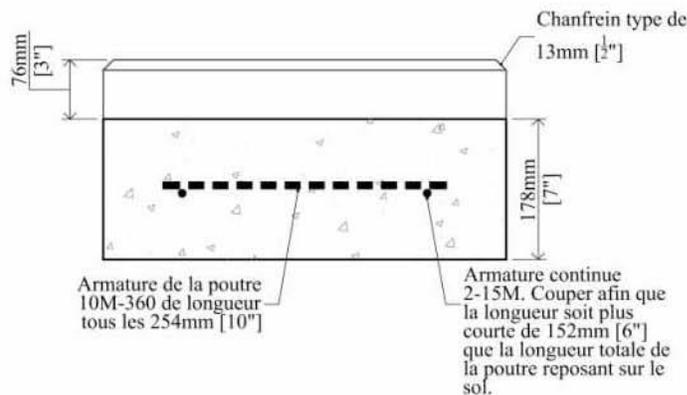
(i) : Poutre de fondation reposant sur le sol pour stèles plates et stèles commandées spécialement – poutre enterrée, stèle surélevée au-dessus du gazon. [C. Chandler, DCP, 2004].
